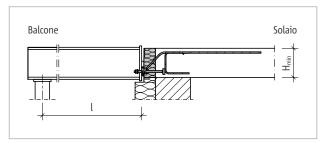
Schöck Isokorb® T tipo SQP: schema statico
